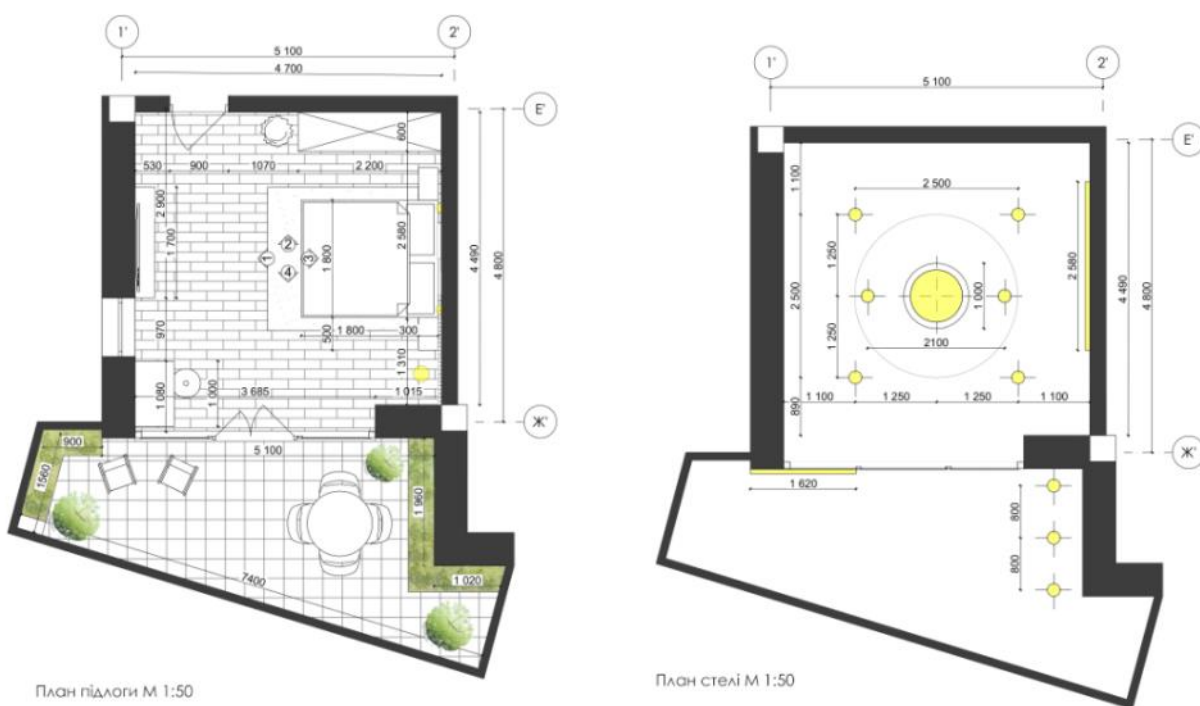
План підлоги та план стелі спальні квартири з виходом на терасу
